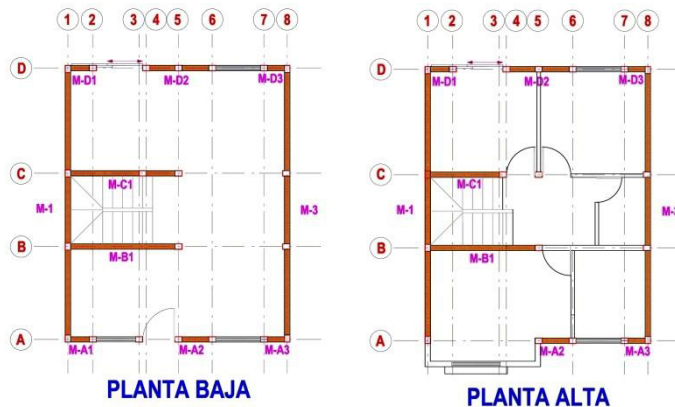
VIVIENDA EN MAMPOSTERÍA CONFINADA
